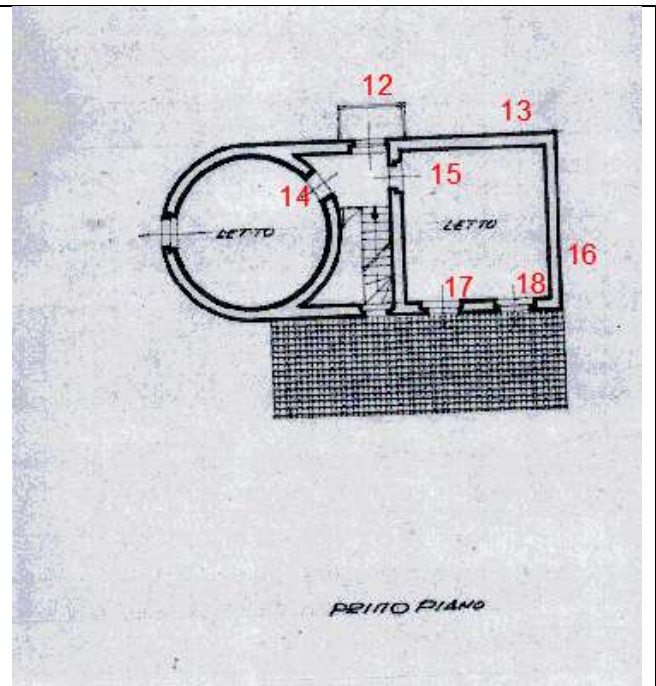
estratto dalla Licenza Edilizia n.2/1978 - piano 1 con individuazione delle non conformità
